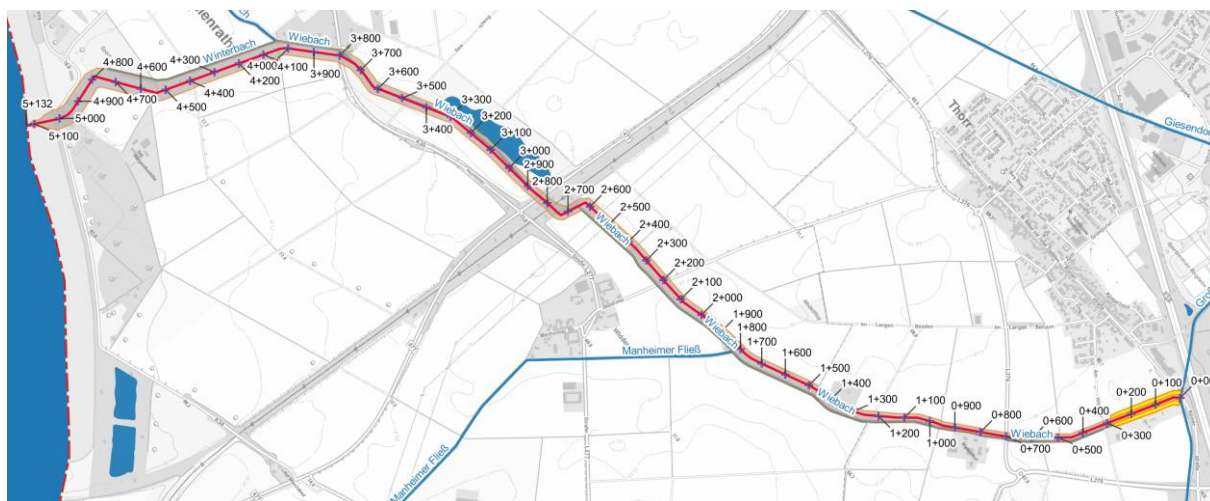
Trasse des Ablaufgewässers gemäß der Vorzugsvariante „Wiebach“ (Übersicht, detaillierte Darstellung vgl. Lageplan B-5.1 zu Anlage 2 – Alternativenprüfung)
